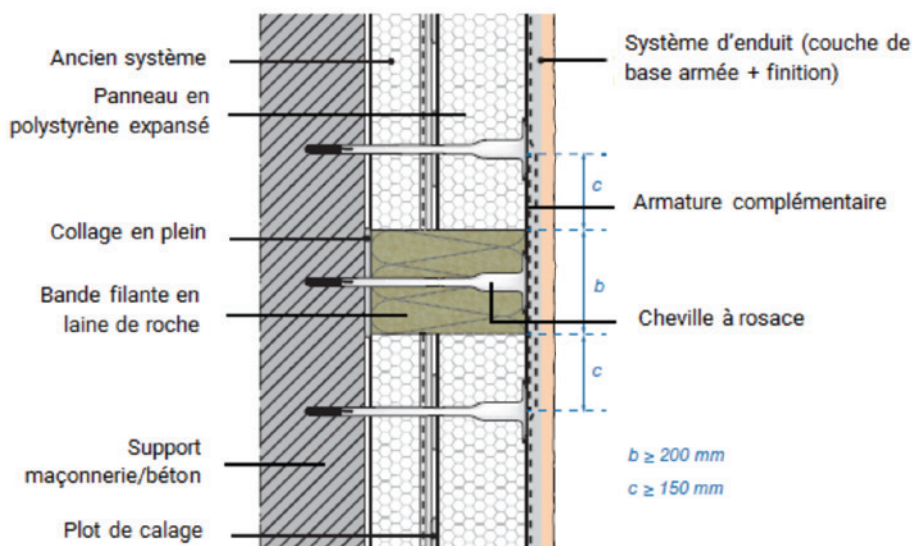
Principe de fixation des bandes filantes sur système d'isolation thermique extérieure existant (coupe verticale)
